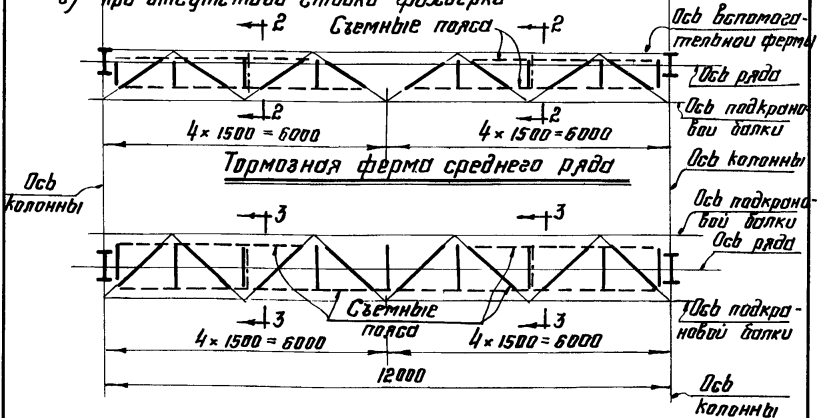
Тормозные балки, фермы и поперечные связи подкрановых балок.
